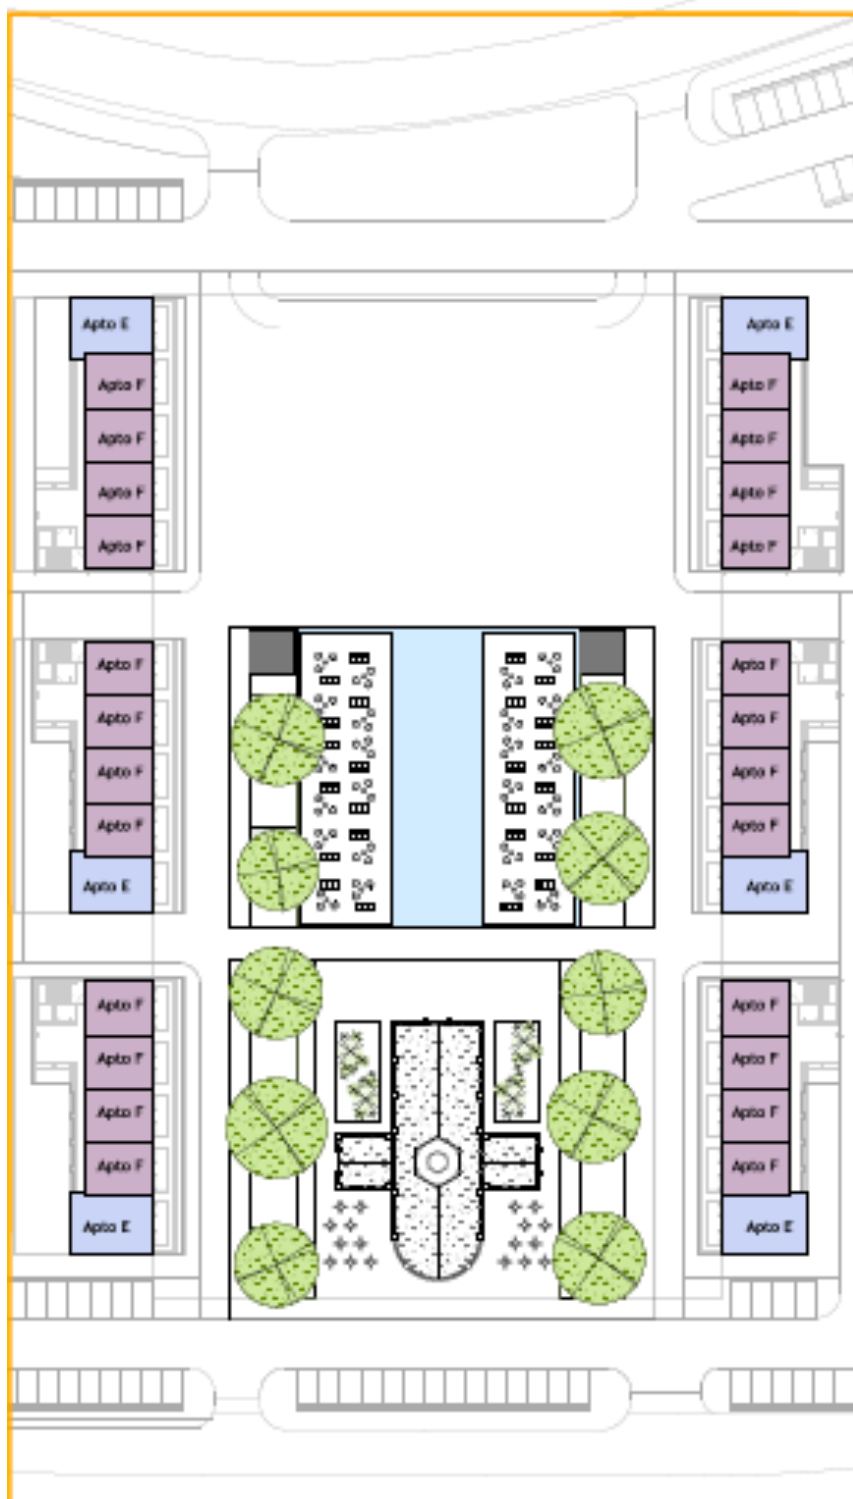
Vista en planta de los apartamentos de la etapa 3
